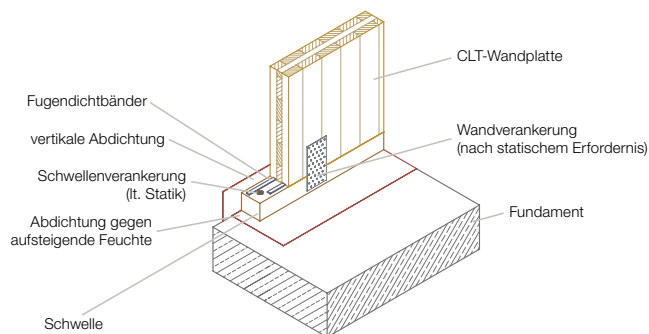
Sockelausbildung mit Schwellenholz (CLT-Stora Enso) (links)
